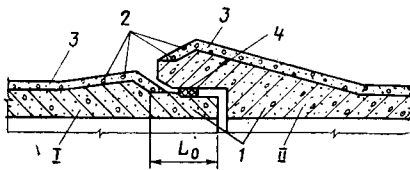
Продольное сечение стыка опытной напорной радиально-прессованной трубы со спирально-перекрестным армированием: 1 — втулочный конец; 2 — раструбный конец; 3 — бетонный сердечник; 4 — спирально-перекрестная арматура; 3 — защитный слой из мелкозернистого бетона; 4 — резиновое уплотнительное кольцо
